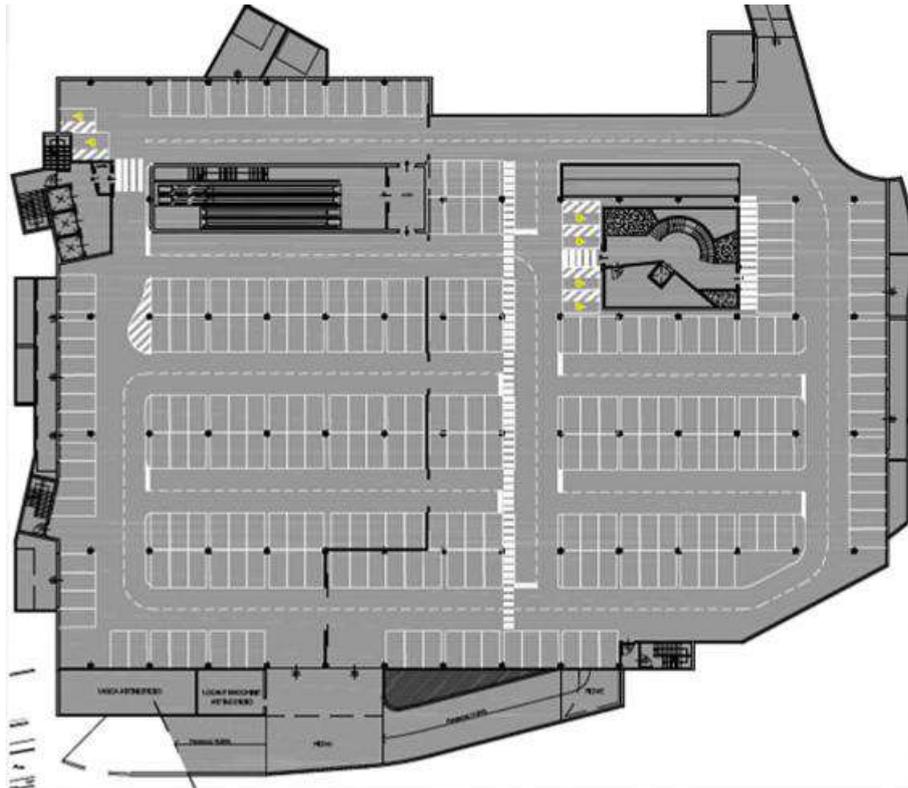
Individuazione aree di sosta – Parcheggio piano -1
